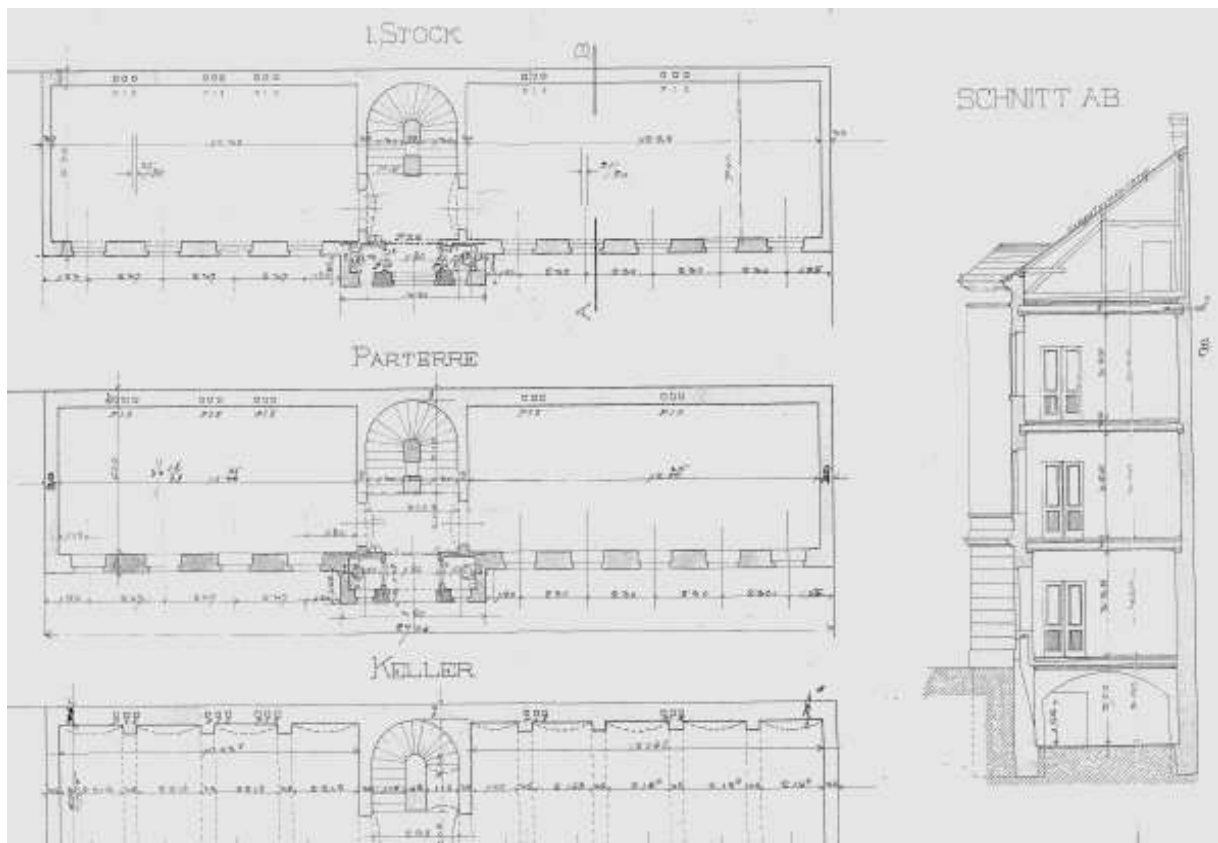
Grundrisse und Schnitt, einfeldriges Gebäude
